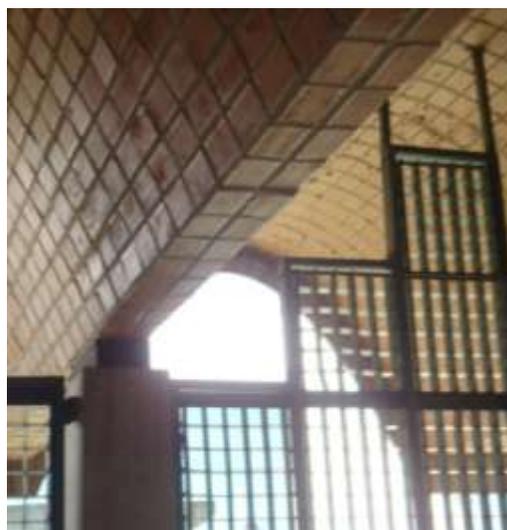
Vista externa do contraste de conexões do pilar, da cobertura e dos brises metálicos. Foto: CANTALICE II.
